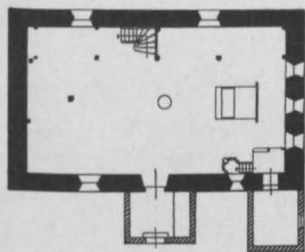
Wehnsdorf. Grundriss der Kirche.
